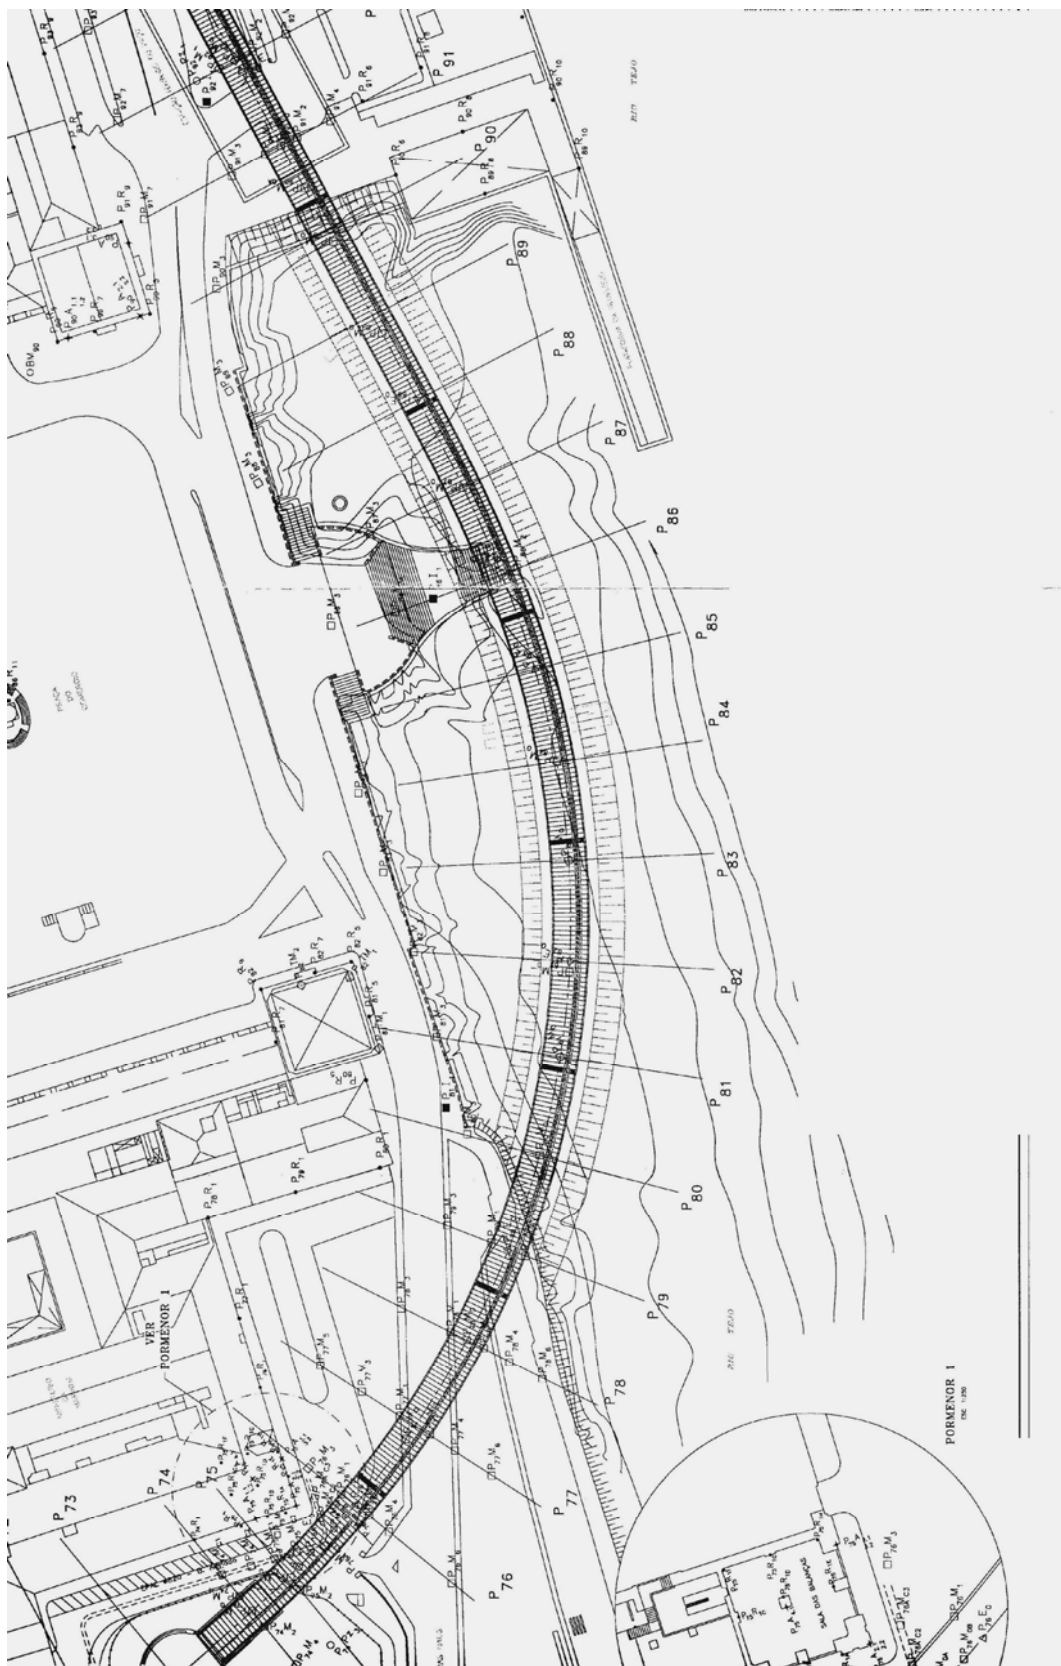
Planta de localização da instrumentação do troço 61 – Poço da Marinha – Terreiro do Paço.
